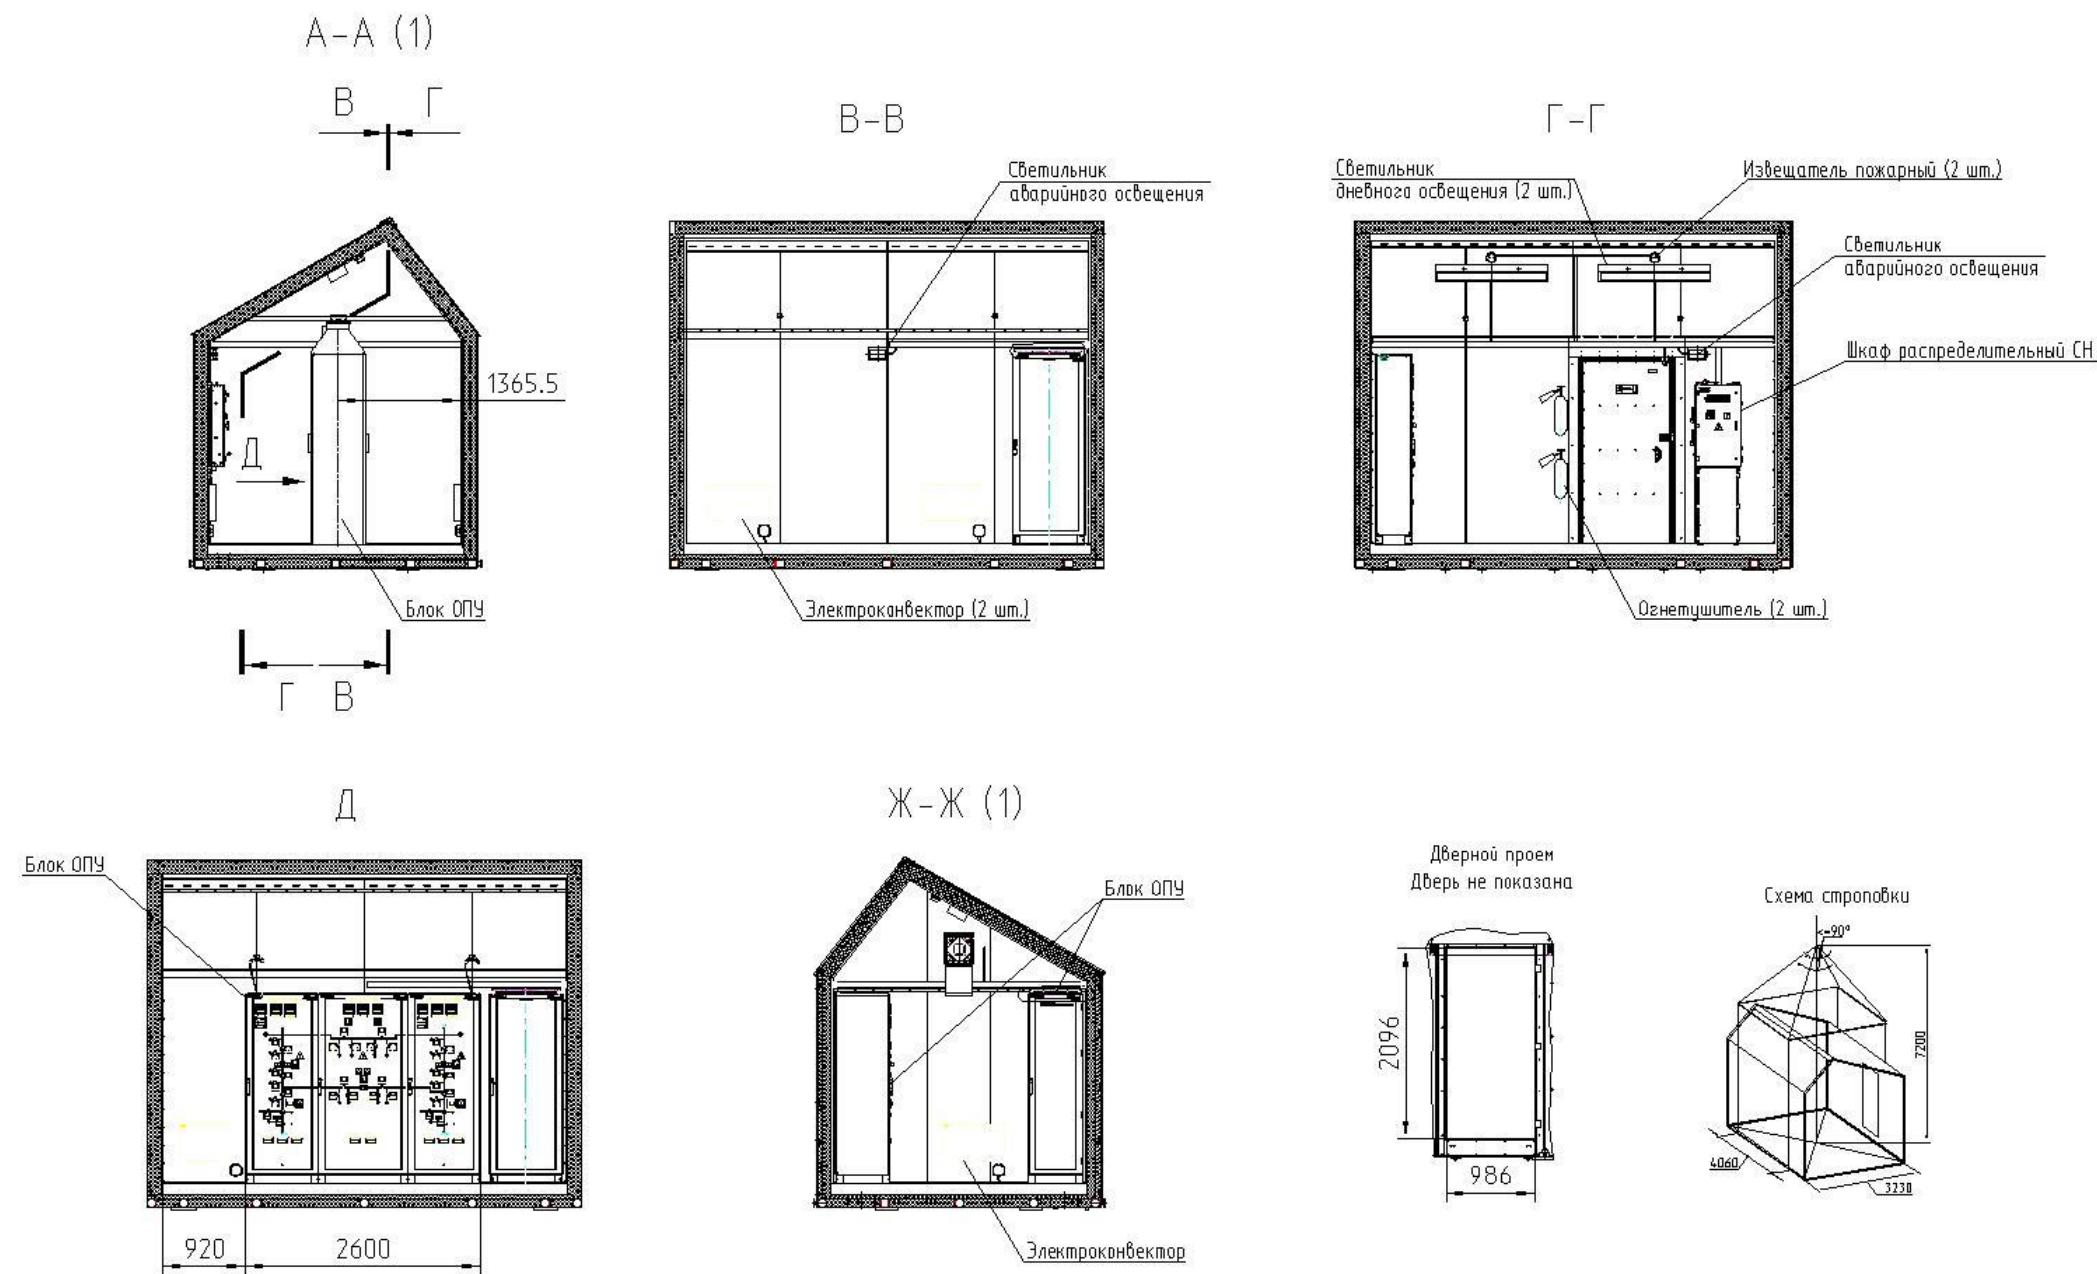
Габаритный чертеж модуля ОПУ типоразмером 4,8 м
